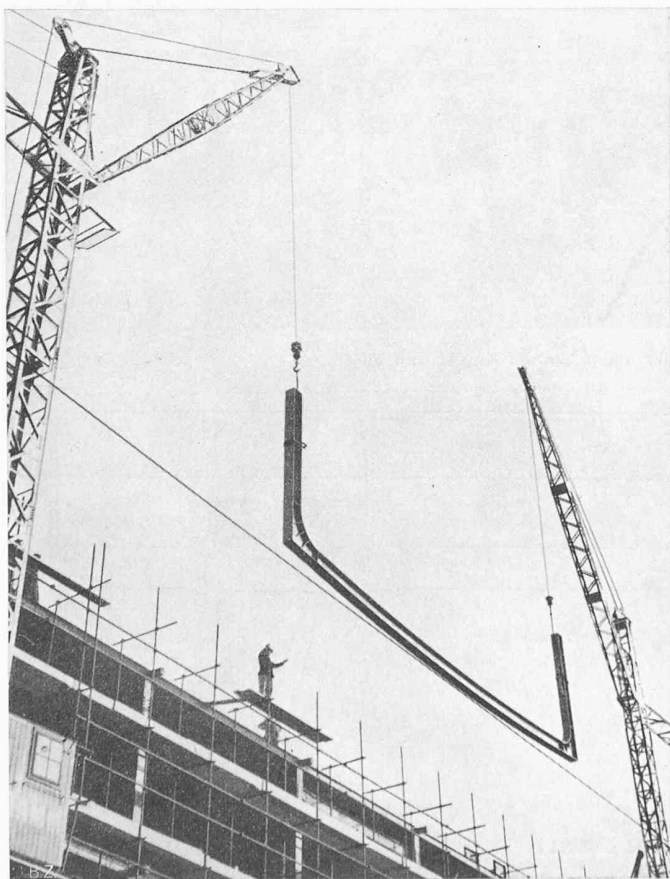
Bindermontage, Stahlrohr-Baugerüst
